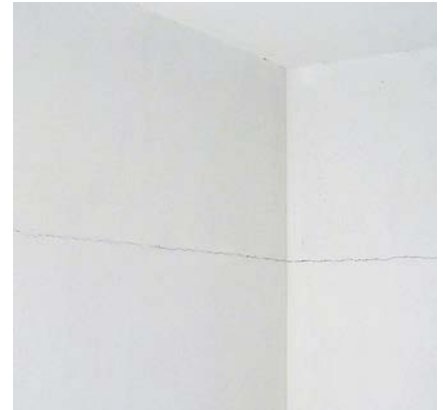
Rissbildung infolge Verkürzung der Decken in Wandlängsrichtung
